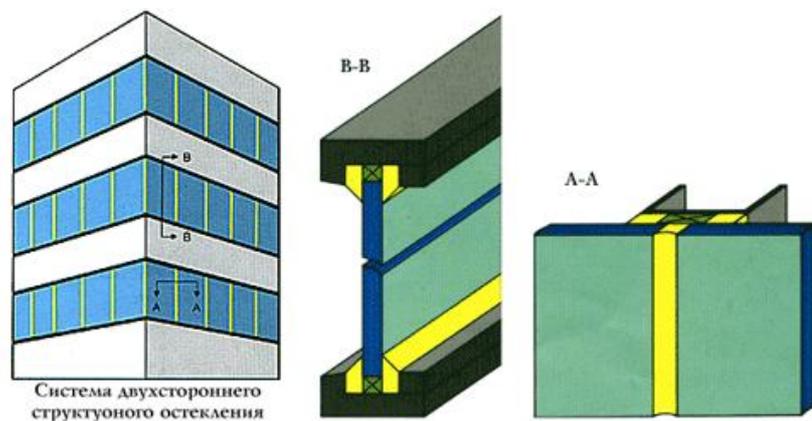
Стоечно–ригельный фасад со структурным остеклением. Двухстороннее крепление.
